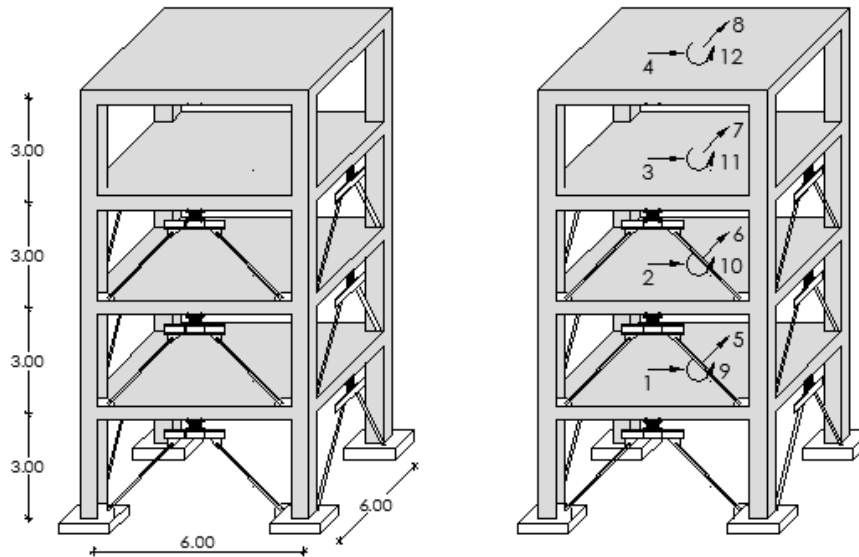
Estructura de concreto armado reforzada con disipadores metálicos. Fuente:(Hurtado & Bozzo, 2008).
